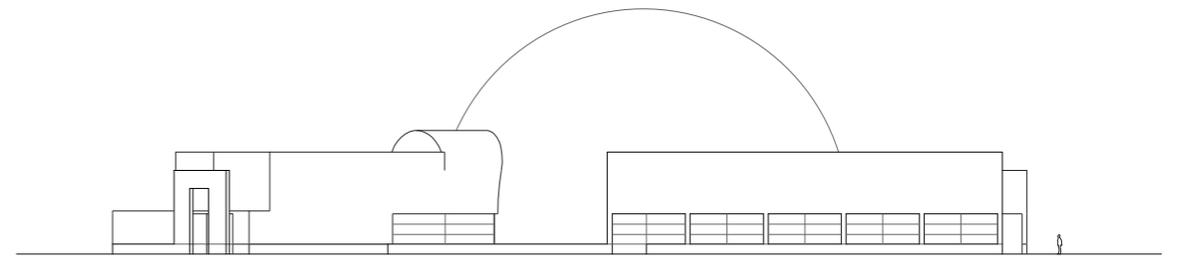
(página siguiente) Alzado sur, desde la Wiener Straße.
